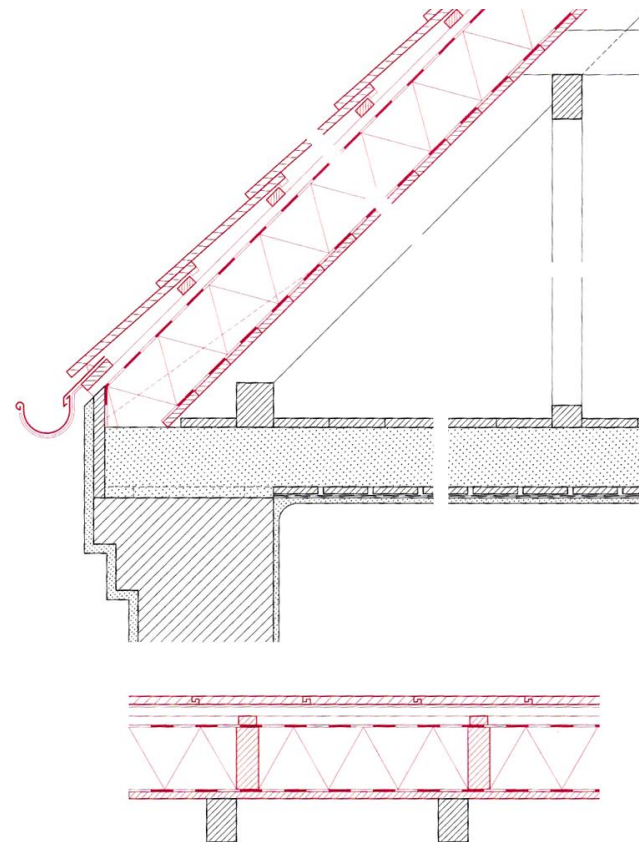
nachträgliche Wärmedämmung eines Steildachs mit sichtbar bleibender Dachstuhlkonstruktion
